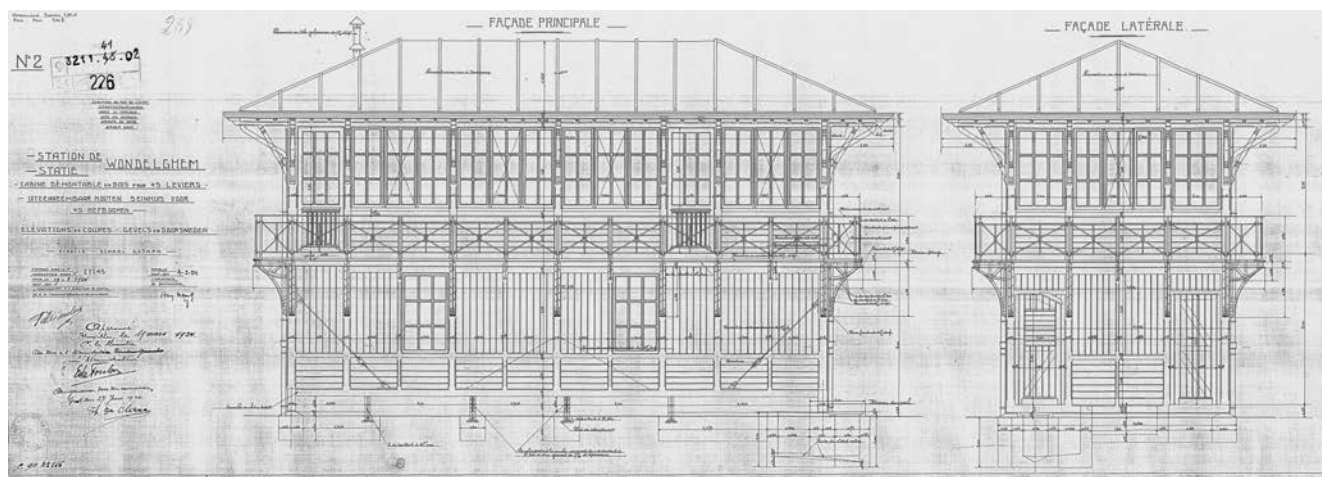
Detail uit een plan van een seinhuis in Wondelgem, voorgevel en zijgevel, 19/02/1924 (Gent, Tekembureau NMBS-Holding, klassement van de plannen, nr. 3211.41.02/226, plan nr. 2, Station de Wondelgem. Uitneembaar houten seinhuis voor 45 hefbomen, (s.d.)). *Detail of the plan for a signal box in Wondelgem, front and side elevation, 19/02/1924.
